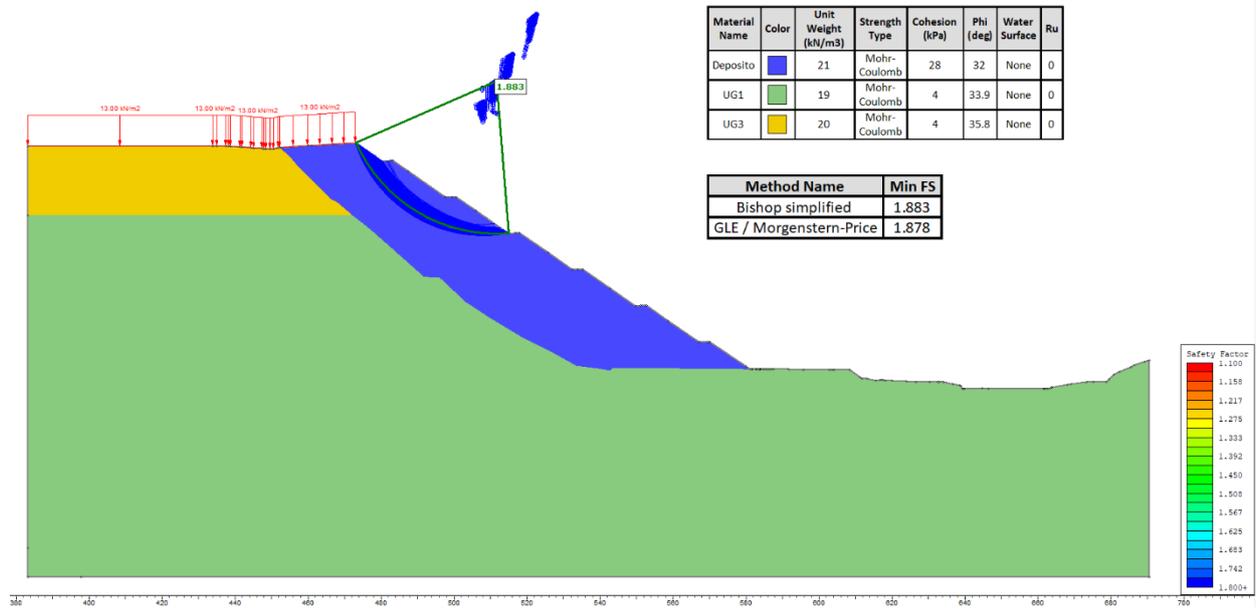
Deposito di Plattner – Analisi di stabilità in campo statico (locale) - Sezione 1-1
